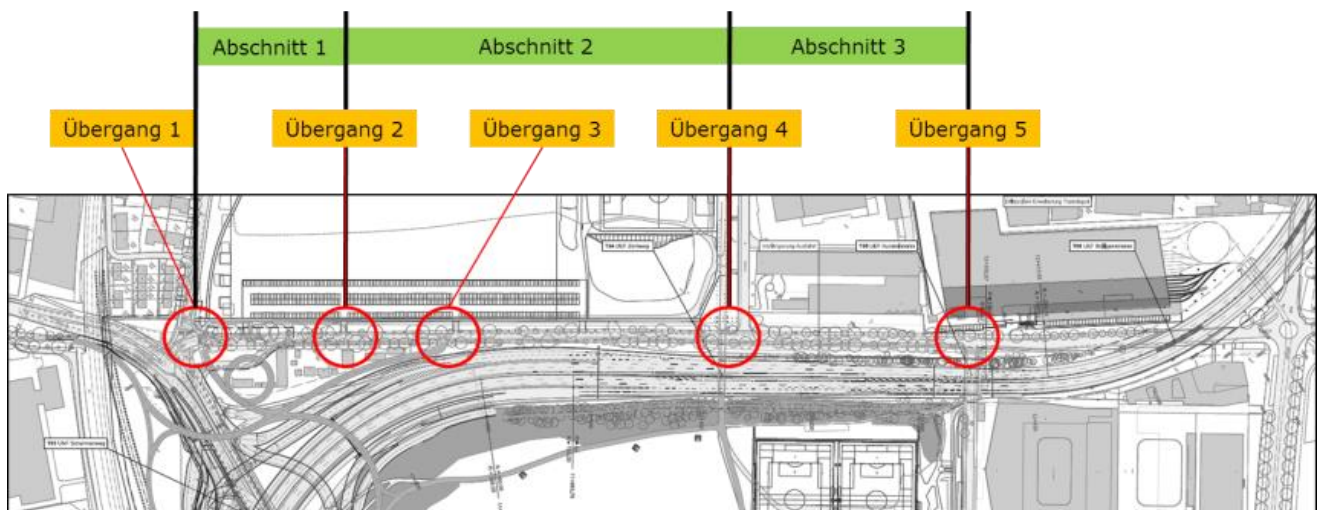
Übersichtplan Bolligenstrasse Süd
